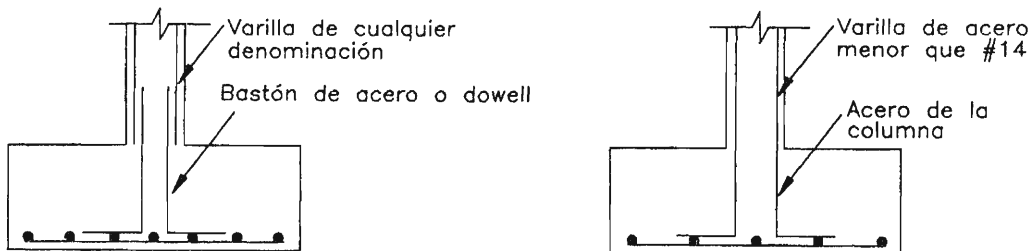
Transmisión de las cargas de la columna a la cimentación
